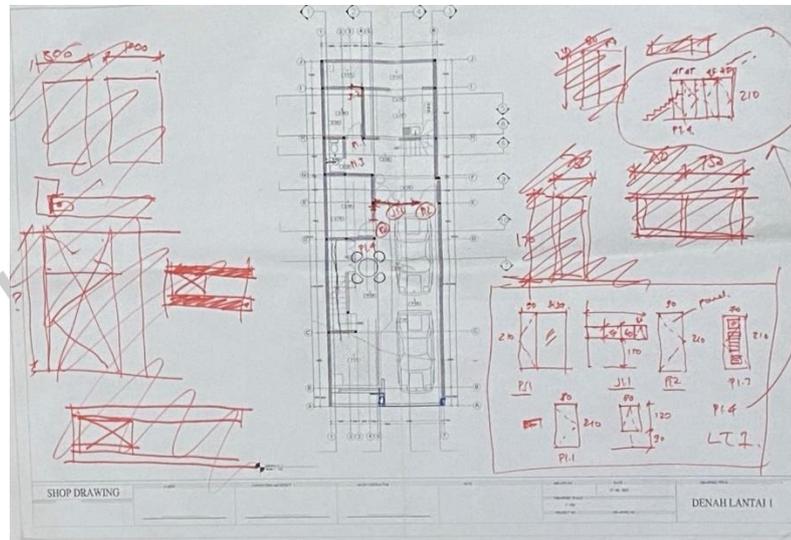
11 Hasil Revisi 1 Denah Lantai 1
